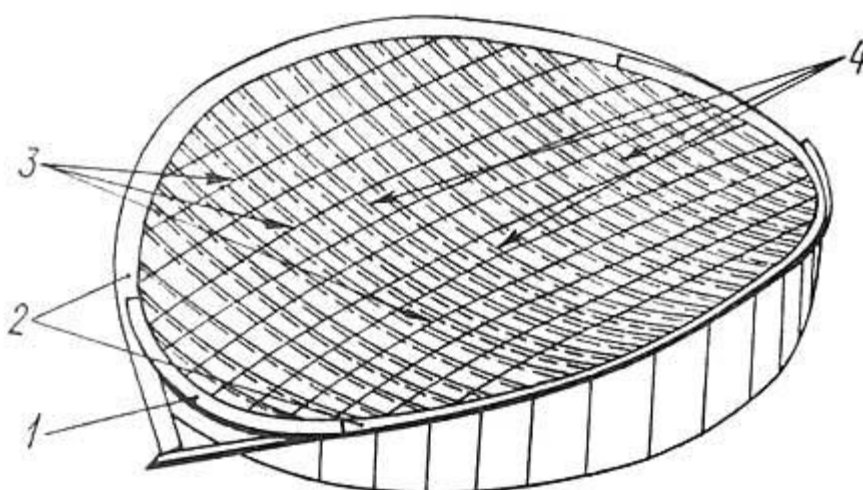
Схема мембранного покрытия: 1 — соединительная железобетонная арка; 2 — основные железобетонные арки; 3 — стабилизирующие тросы; 4 — несущие ванты из листовой стали
